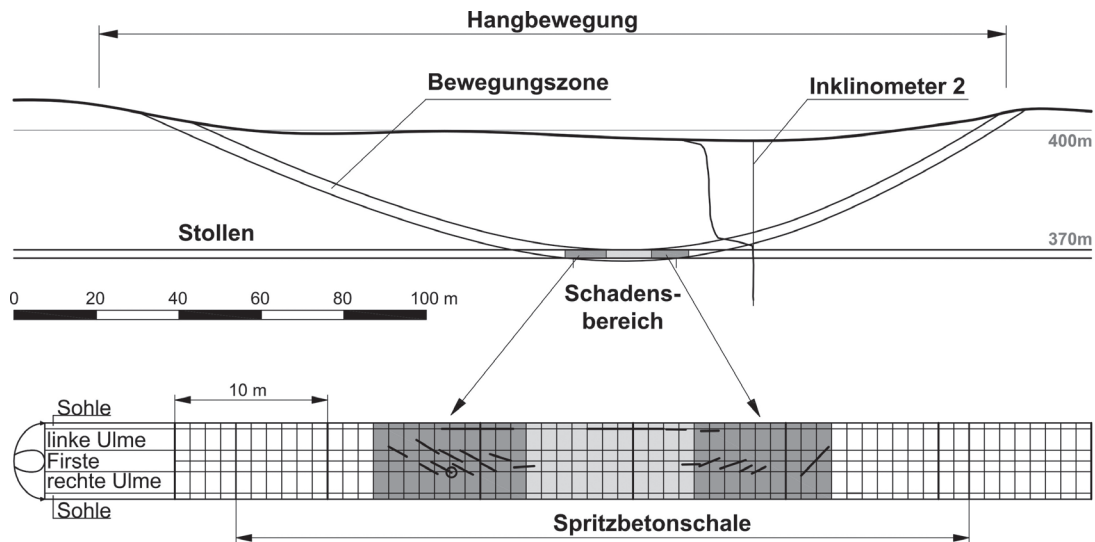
Rissbild in der Spritzbetoninnenschale (Ulmen und Sohle hochgeklappt und in den Grundriss projiziert); kleiner Kreis: Position des Fissurometers und der Schwingende Saite – Sensoren (Abb. 5); nach Einbringung der Spritzbetoninnenschale wurde das Fissurometer, mittels dessen die Verschiebungen der Ufer des Risses im Stollenausbau parallel zur Stollenachse gemessen wurden, in einem Fenster im Spritzbeton wieder montiert.
